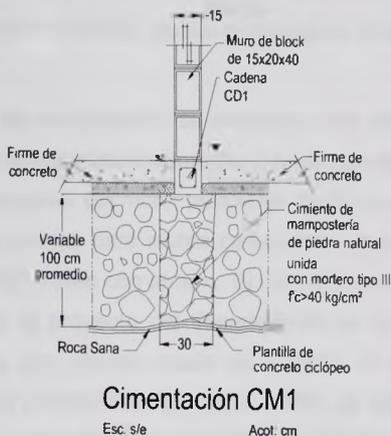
Detalle de cimentación a base de mampostería de piedra.
